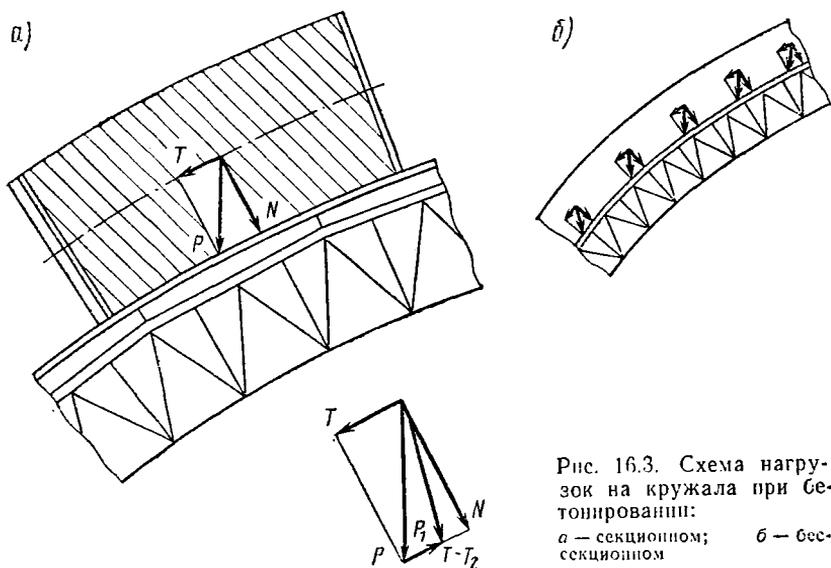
Схема нагрузок на кружала при бетонировании:
